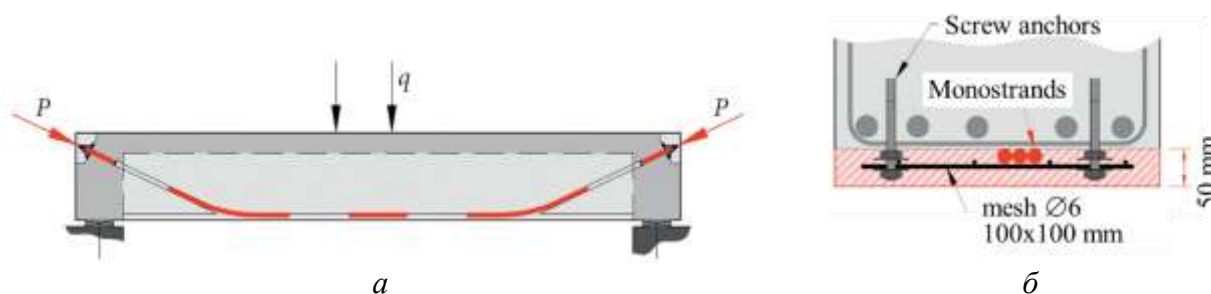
а — усиление плитно-ребристых железобетонных балок путем укладки монострендов в пробуренные ранее каналы и последующего их натяжения; б — армирование защитного слоя бетона (источник [11])
